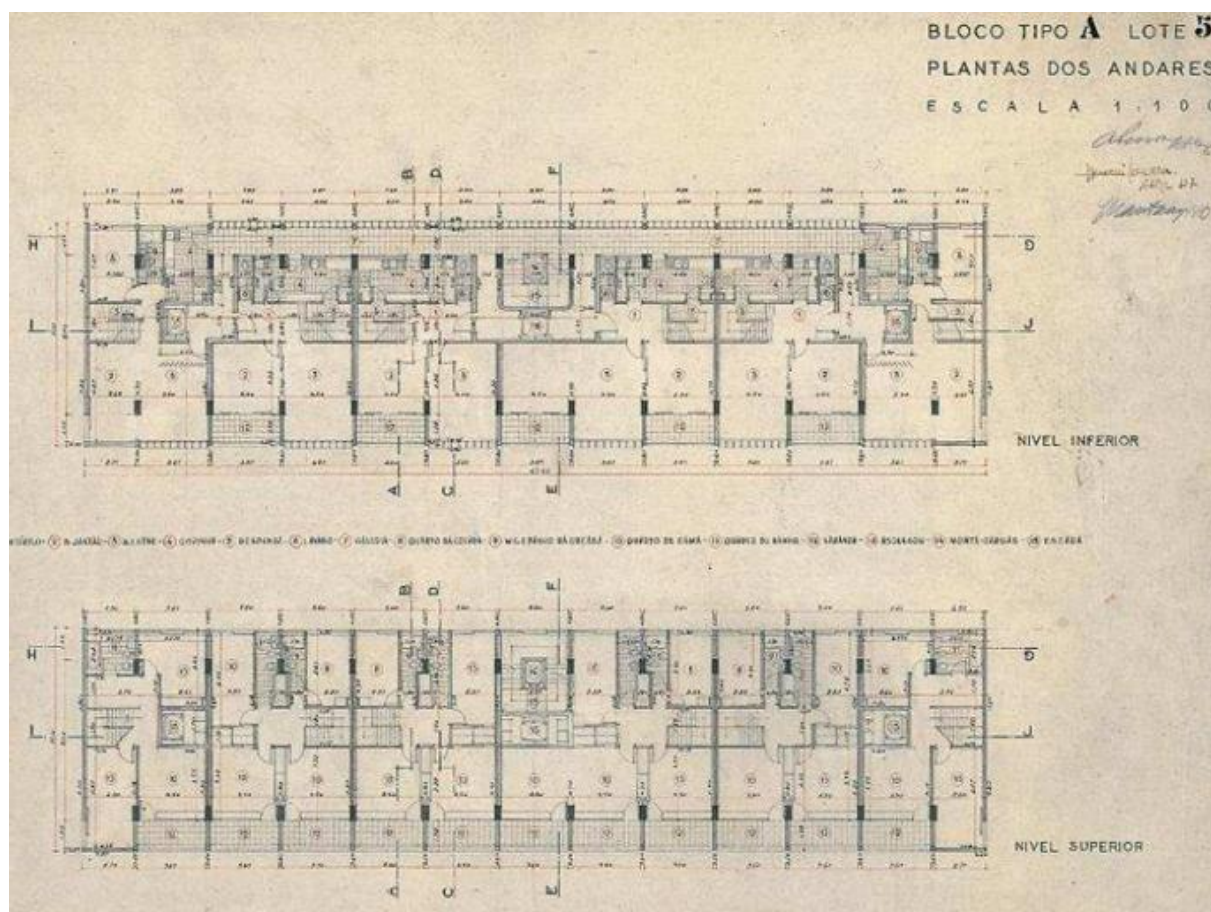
Planta dos andares Lote 5 (Projeto 1952-1955) (Pessoa, 1940).
